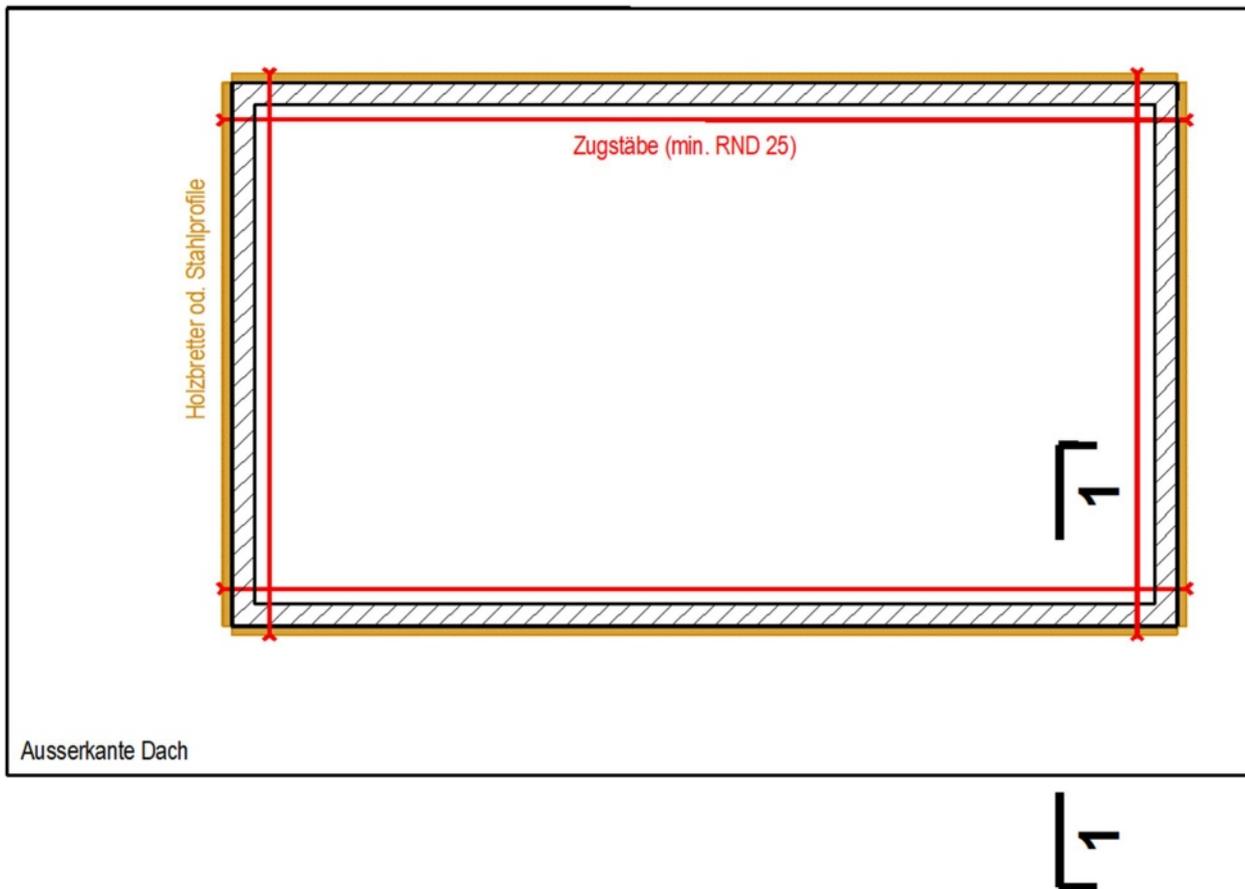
Grundriss mit innenliegenden Zugstäben zur Stabilisierung des Mauerwerks
